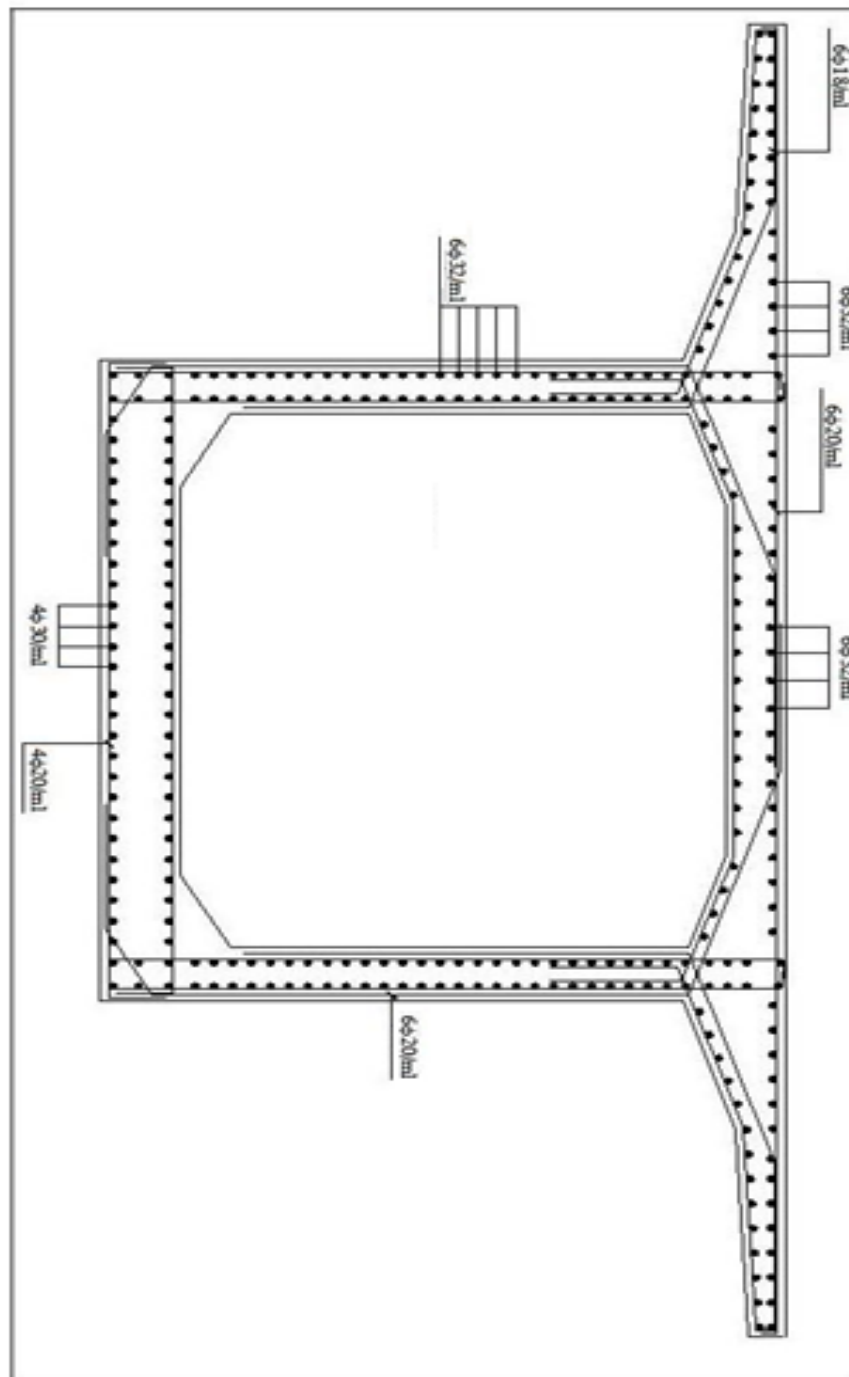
Schéma du ferrailage passif du voussoir sur pile
